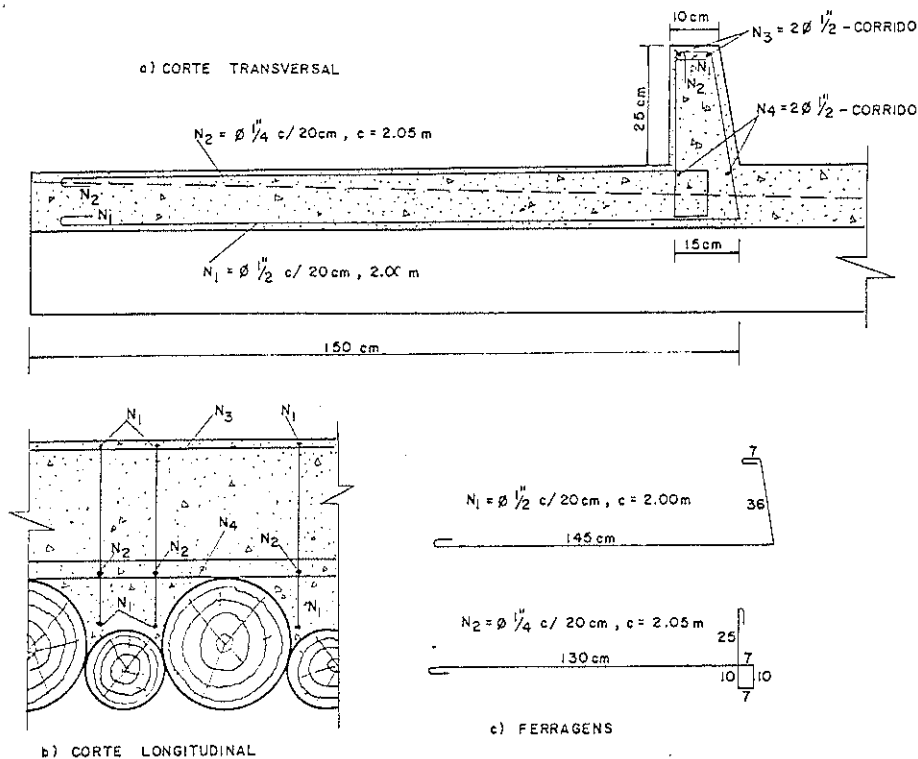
O GUARDA - RODAS , DIMENSÕES E FERRAGENS
